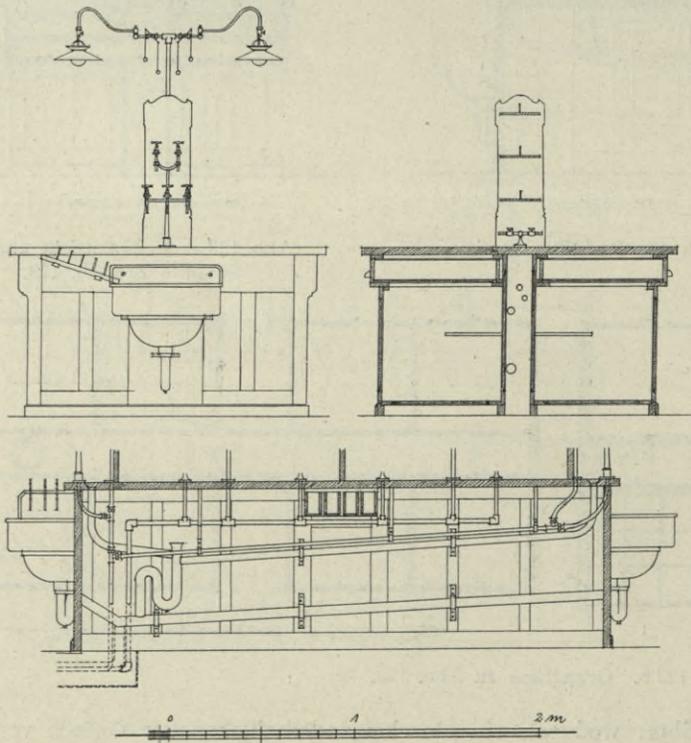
c/d. Seitenansicht und Schnitte zu Abb. 124 a/b.
